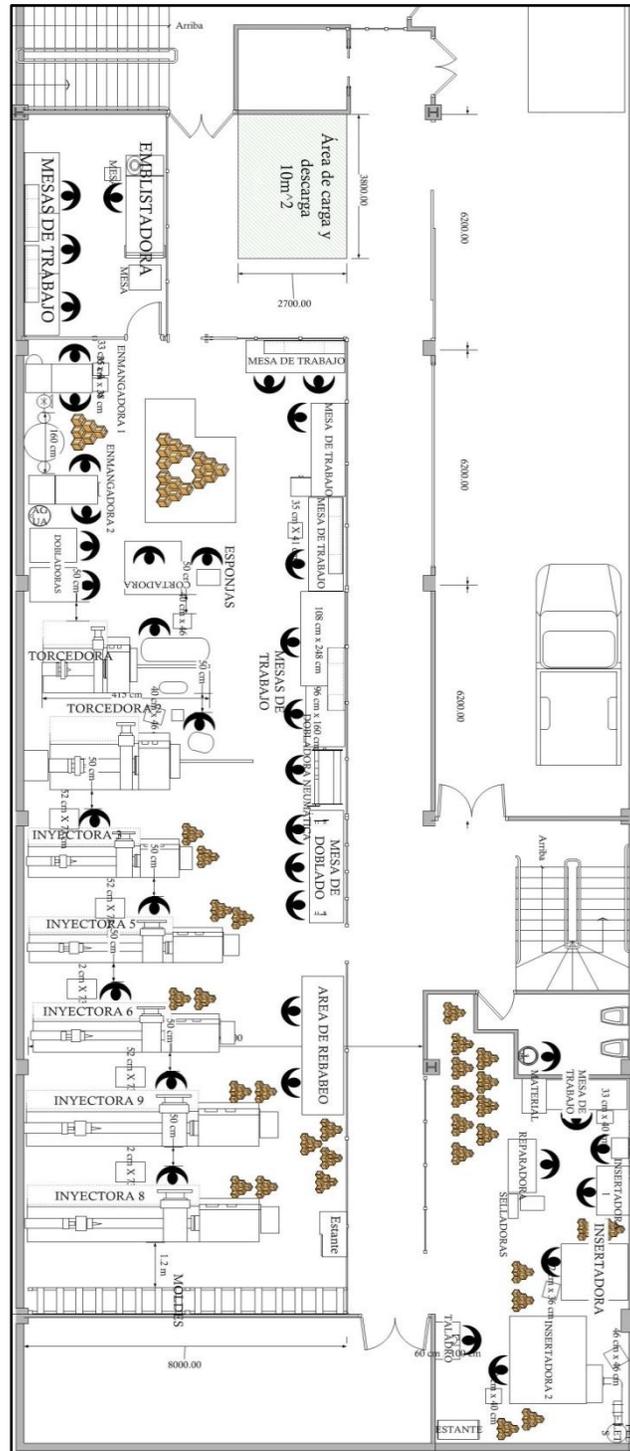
Planta baja de la nueva planta (elaboración propia).
